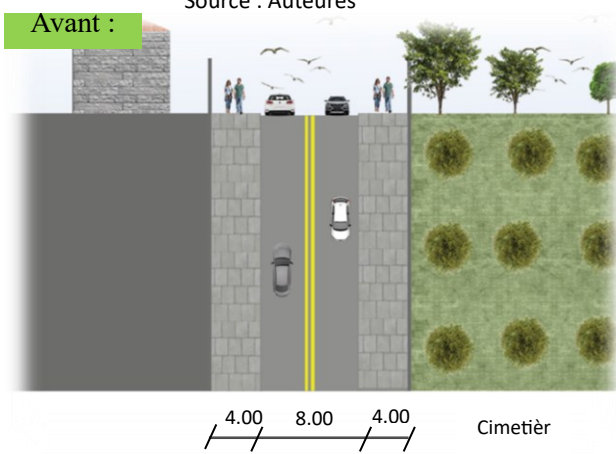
plan et coupe de la rue Mellouli Ahmed Avant l'intervention.
